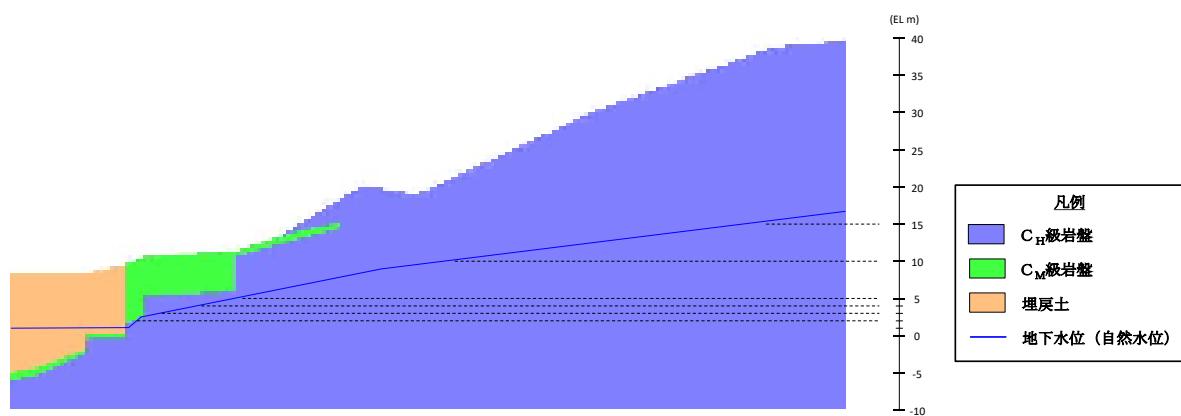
解析モデル断面図 (図 3.3-16 a-a' 断面)
